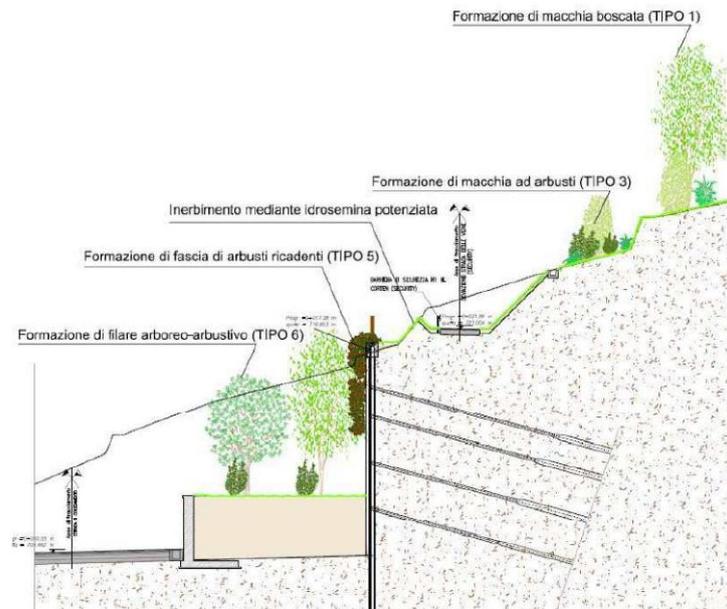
Sezione tipica della berlinese e del muro antistante degli interventi di mitigazione.
